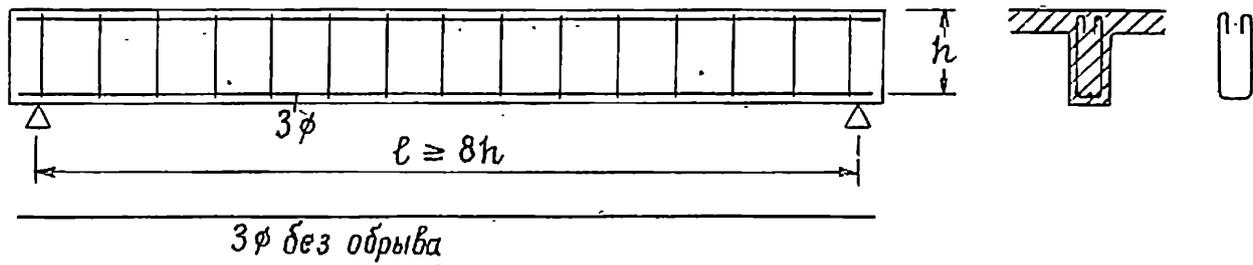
6. Балки слабо загруженные равномерной нагрузкой (обрыв продольной арматуры не оправдывает себя).
